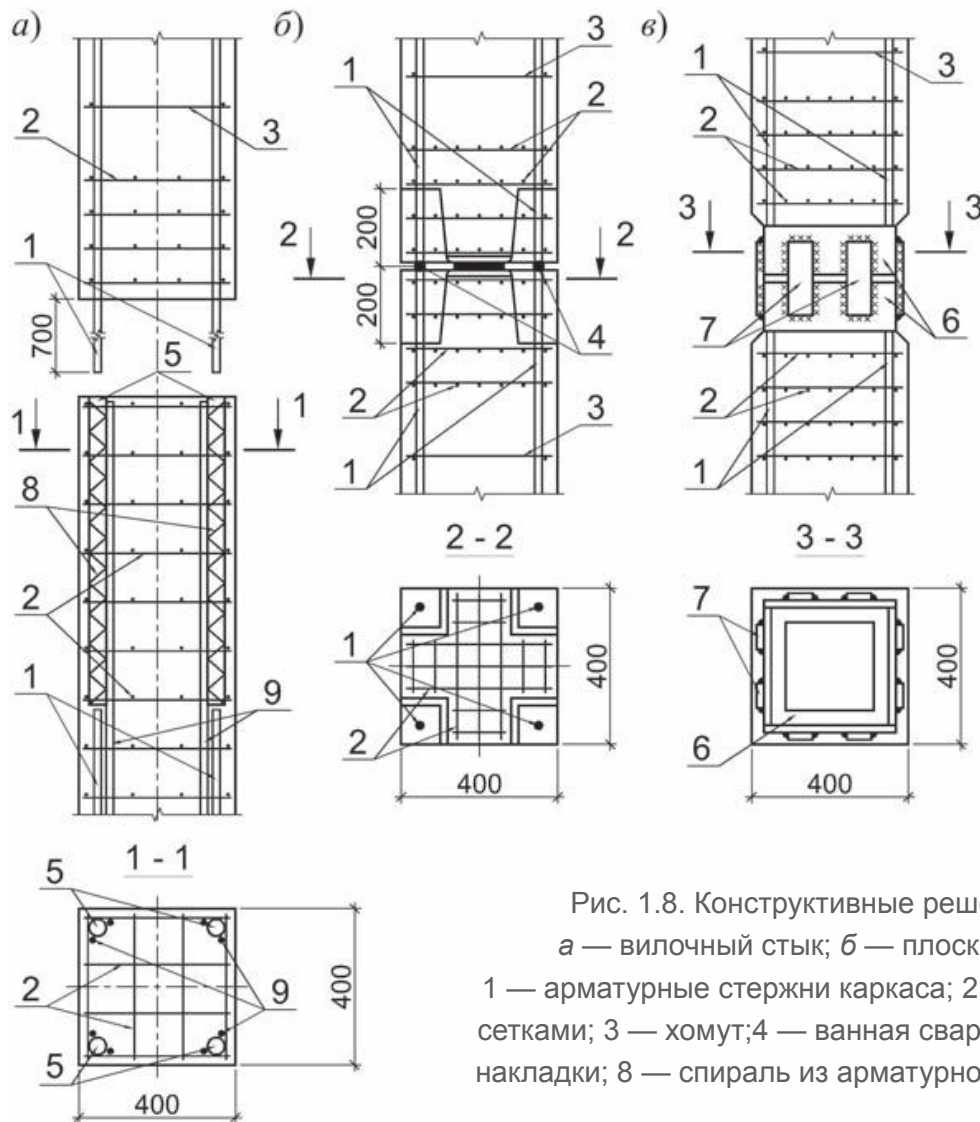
Конструктивные решения жестких стыков железобетонных колонн:
